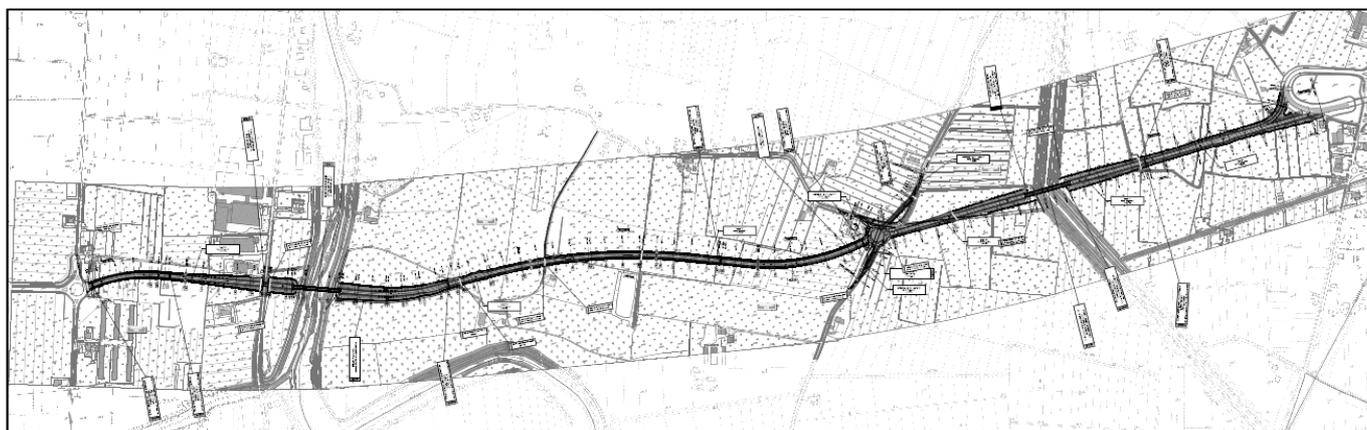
Planimetria di Progetto – Opera 1RE
